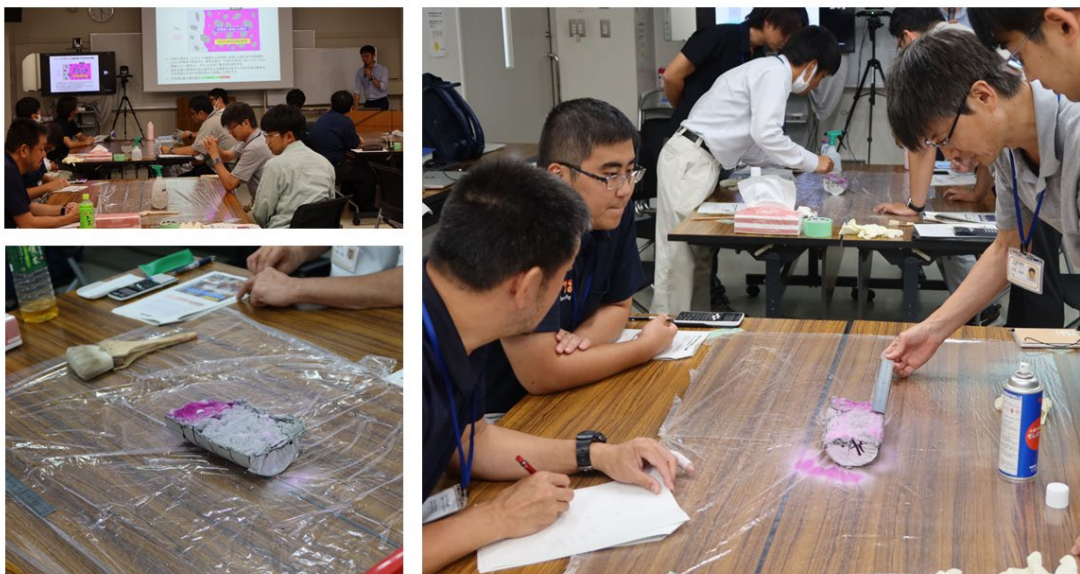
室内実習（コンクリートの耐久性試験）の状況
